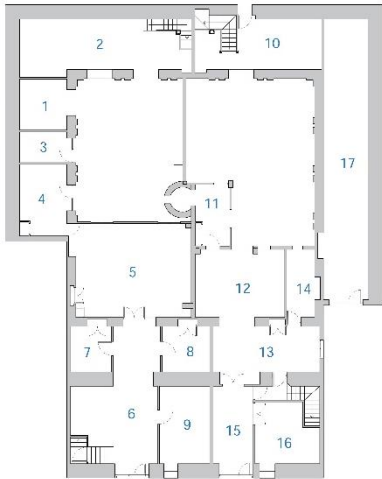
Numeración estancias planta inferior (Alejandro Serra 2016).
